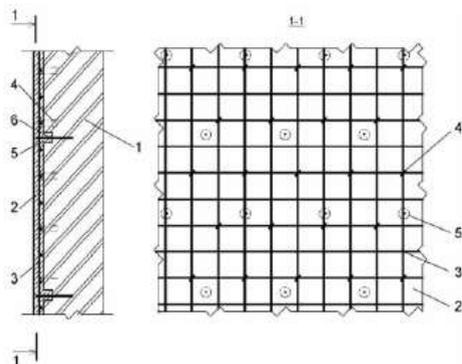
Схема усиления каменной кладки железобетонной рубашкой со шпонками.
